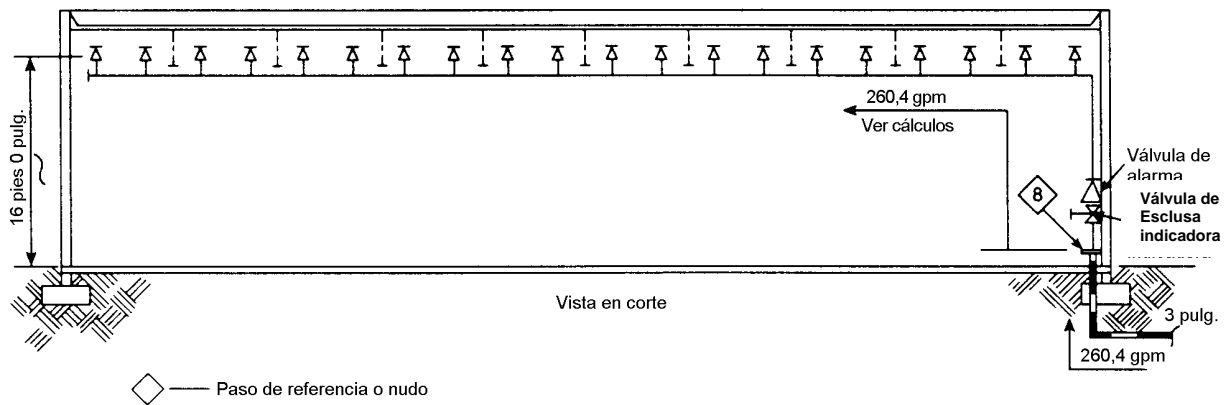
(b) Ejemplo de cálculo hidráulico (vista en planta y elevación).
